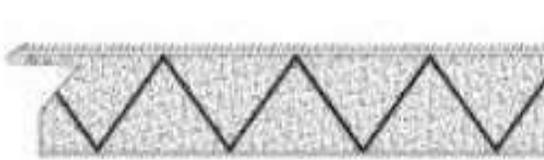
Detalle constructivo del sistema terrapanel solución 1
